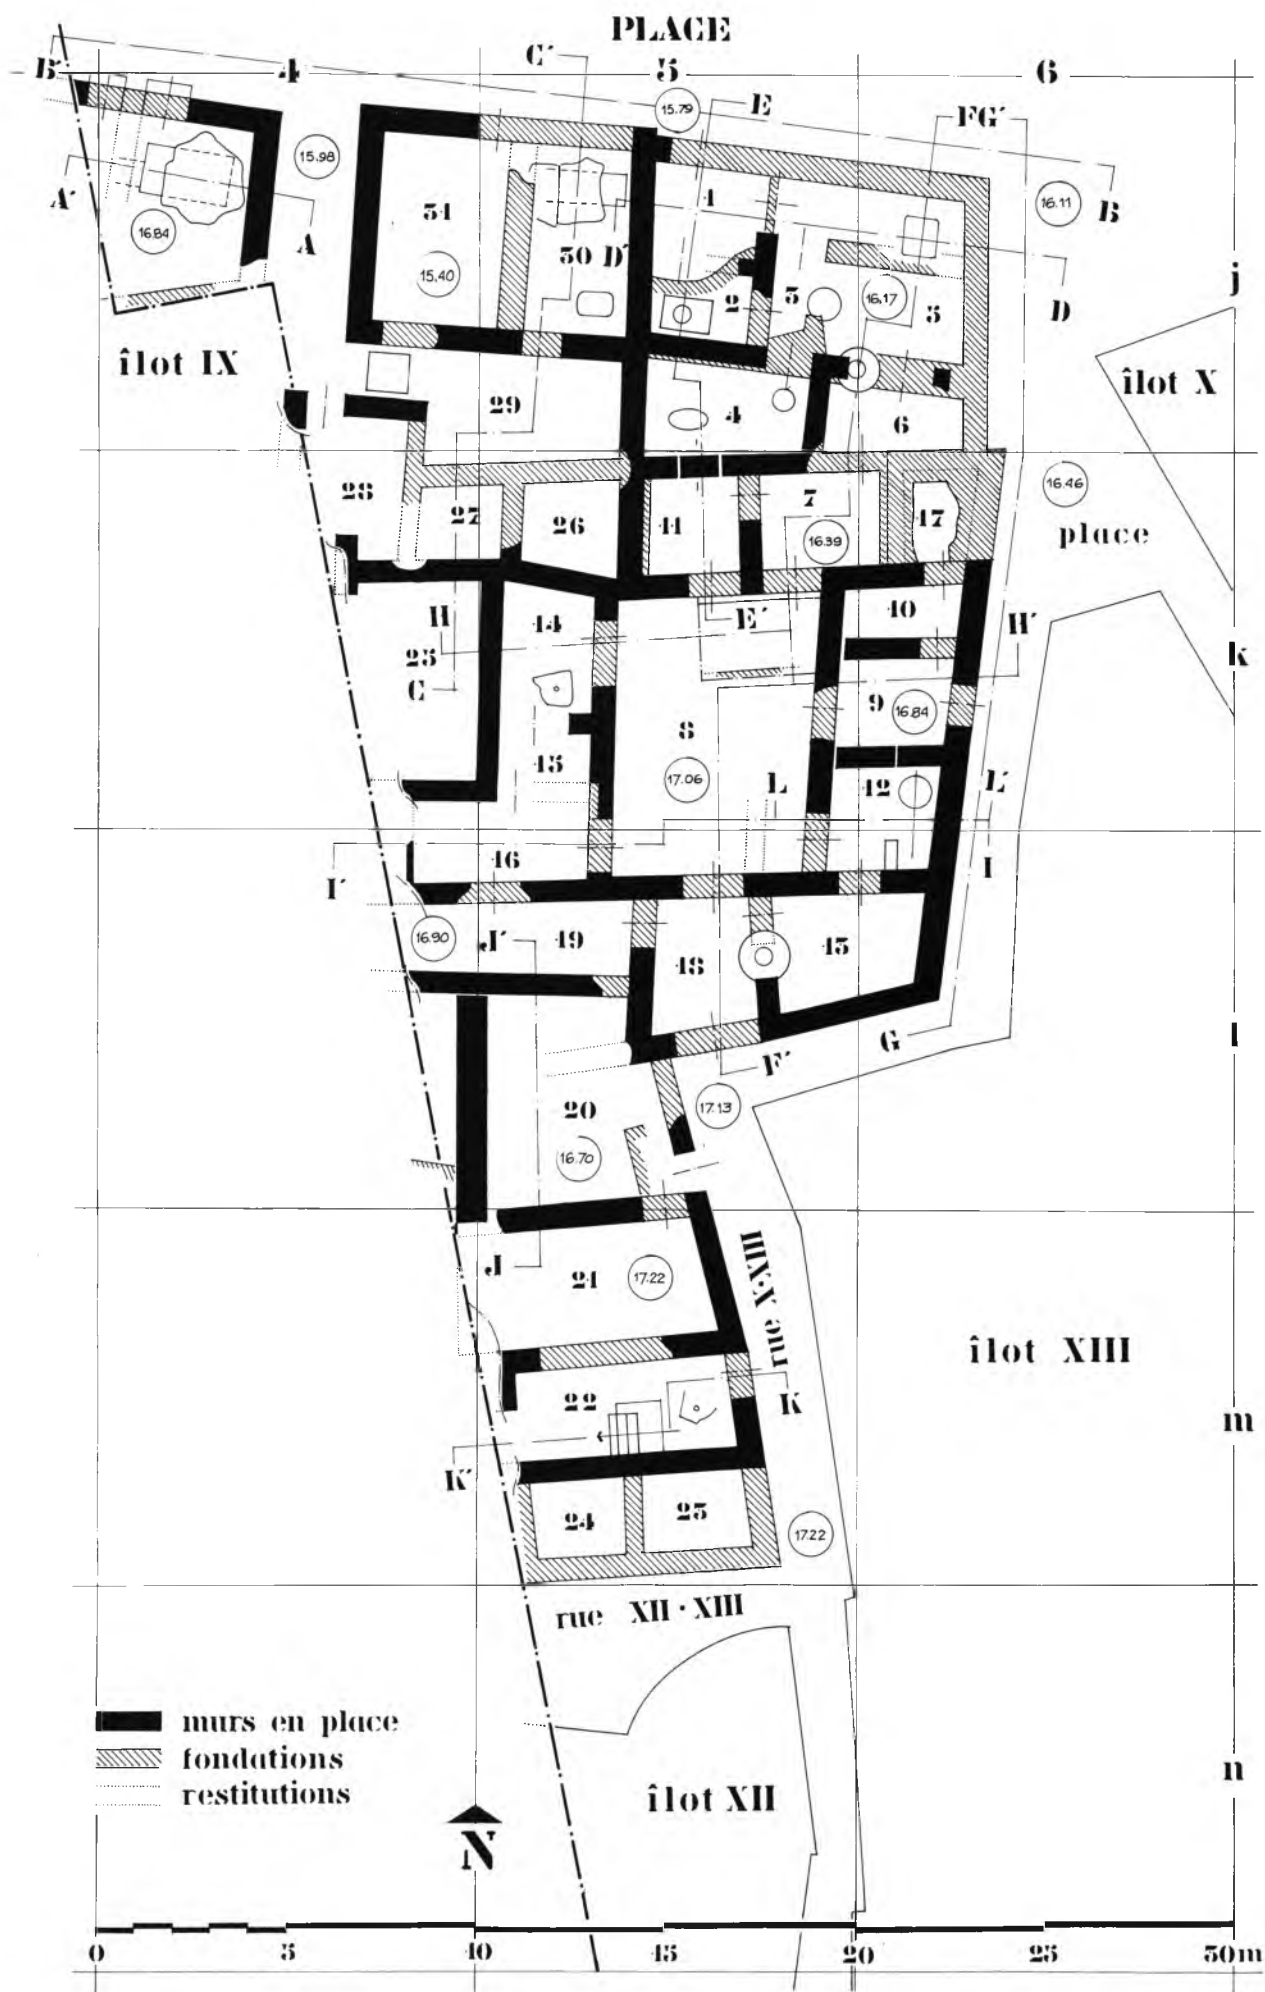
Îlot VIII : Essai de reconstitution du plan.
